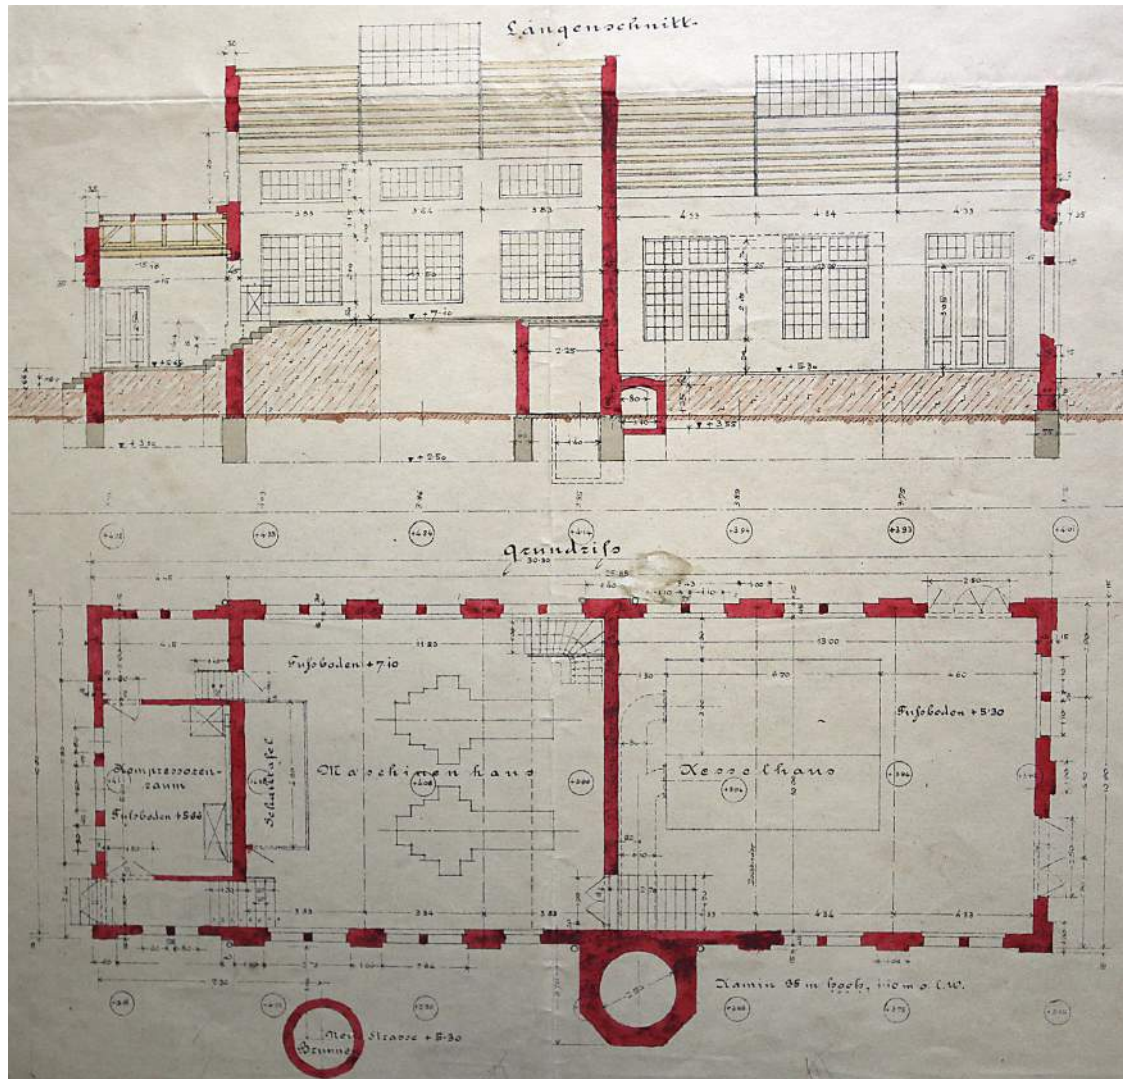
Ausschnitt aus dem Entwurfsplan von 1911
